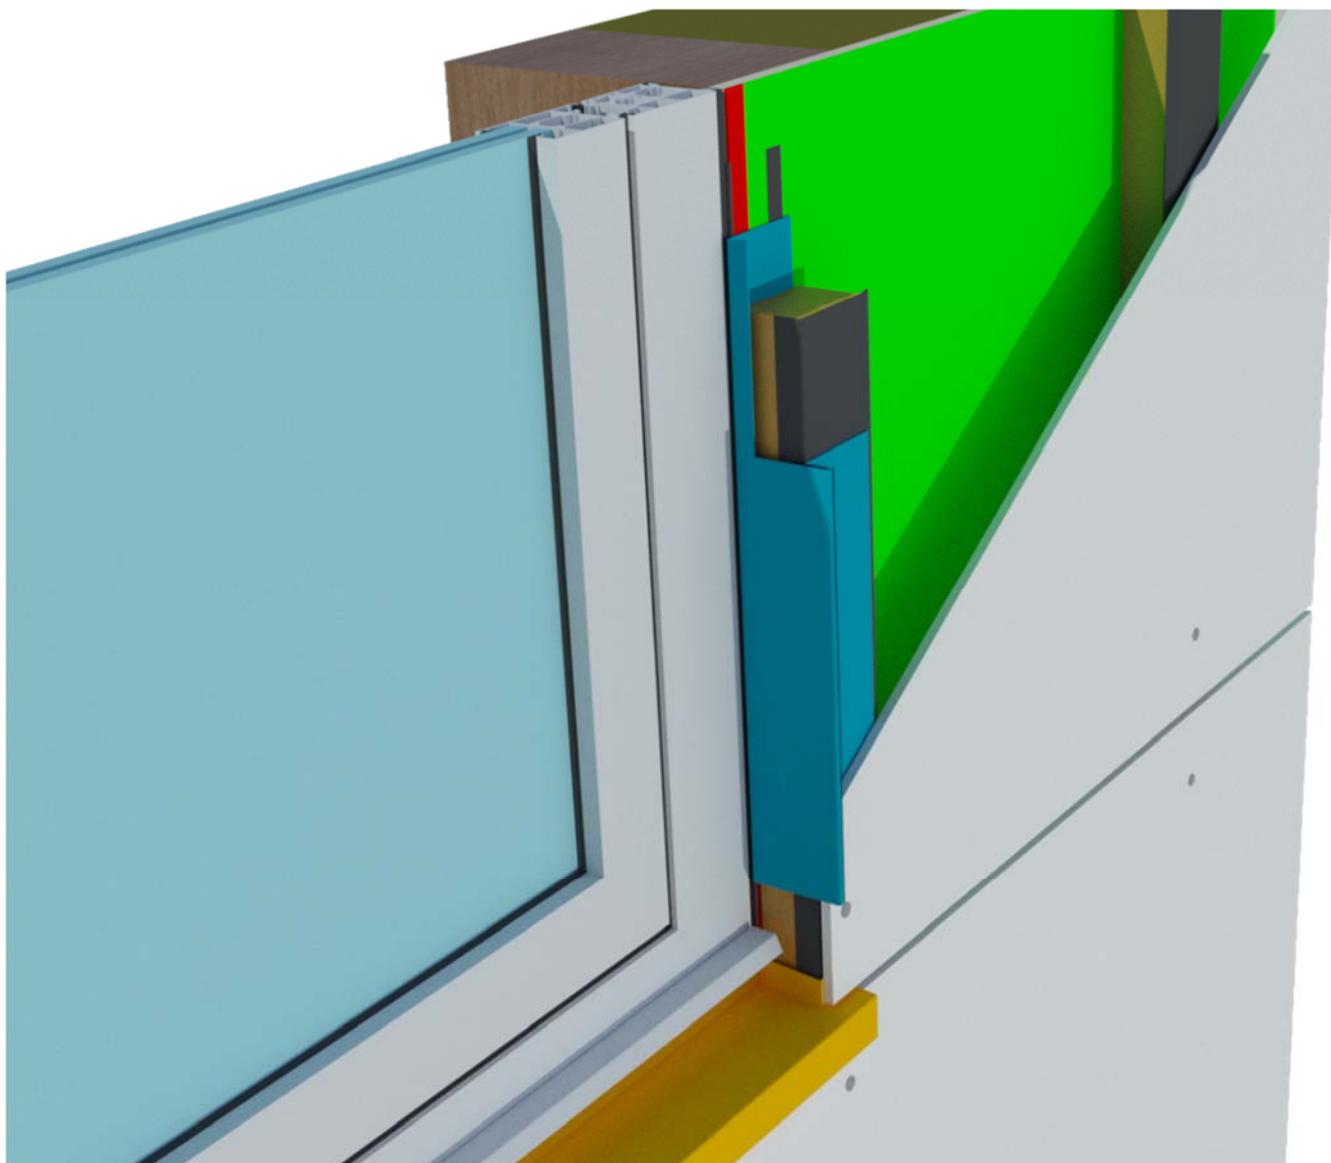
Pose sur COB – Dispositions particulières du traitement des baies Menuiserie en tunnel au nu extérieur – Coupe sur linteau de baie
